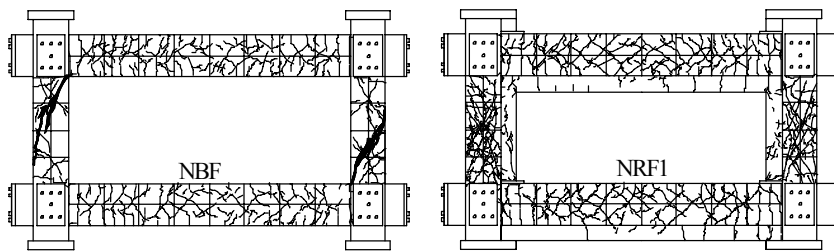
試験体 NBF および NRF1 の $R=1/50rad$ におけるひび割れ状況
